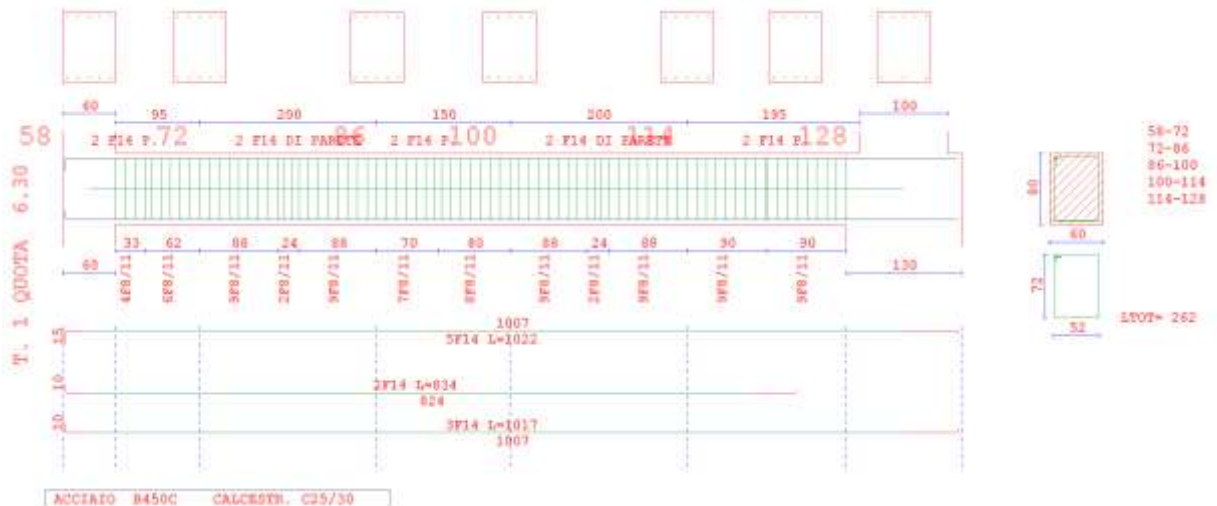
Armatura trave telaio 6 quota +6.30
